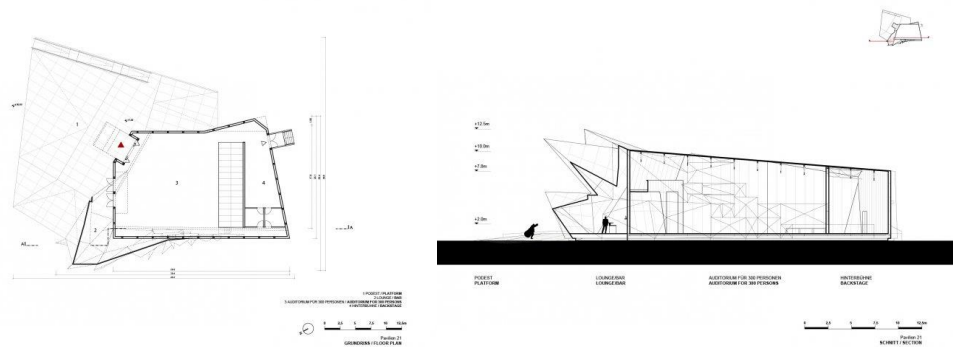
Planta e Corte do Pavilion 21 MINI Opera Space .
